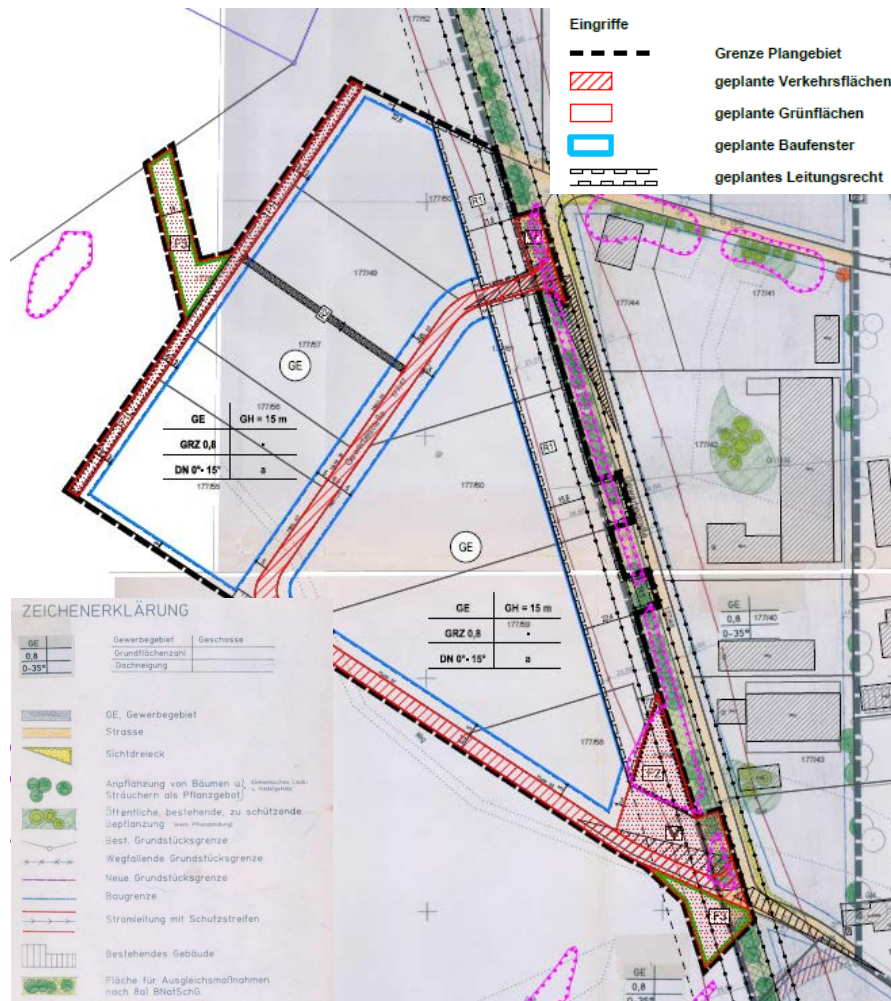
Plangebiet in Überlagerung des Bebauungsplans "Signauer Schachen" (Quelle galaplan decker, Bebauungsplan)
